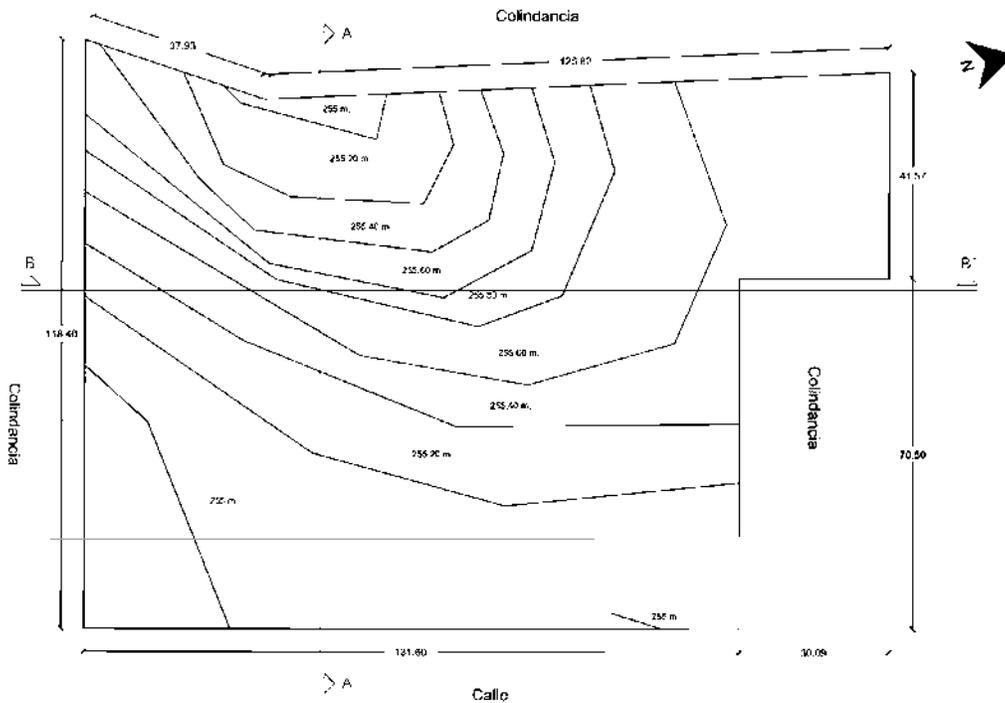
Croquis del predio para el proyecto muestra la infraestructura existente.
